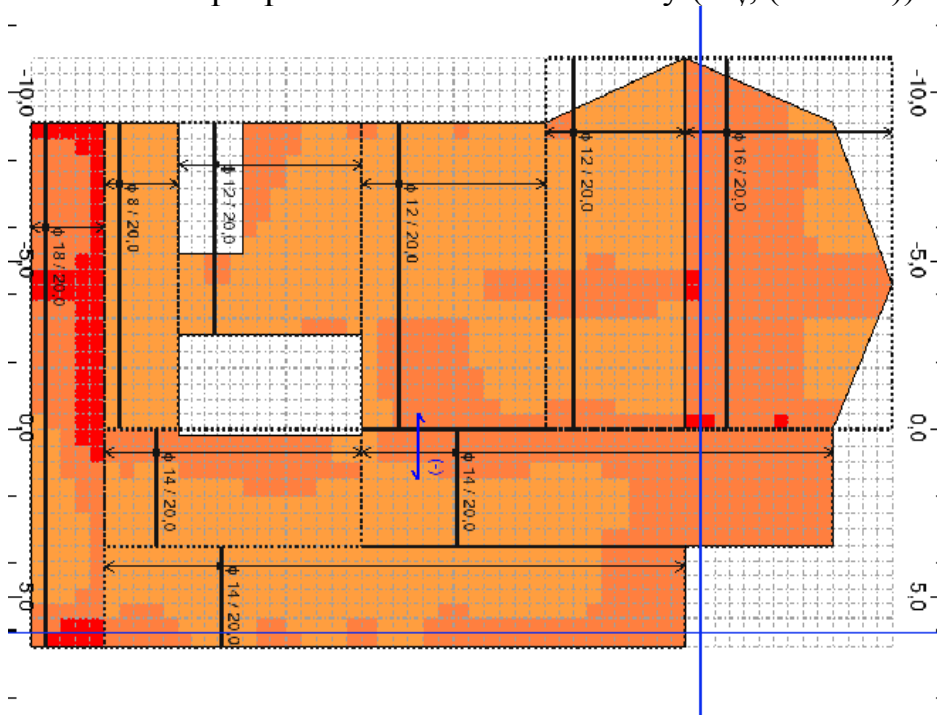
Схема армирования элементов пластин перекрытия (нижняя по оси x)
